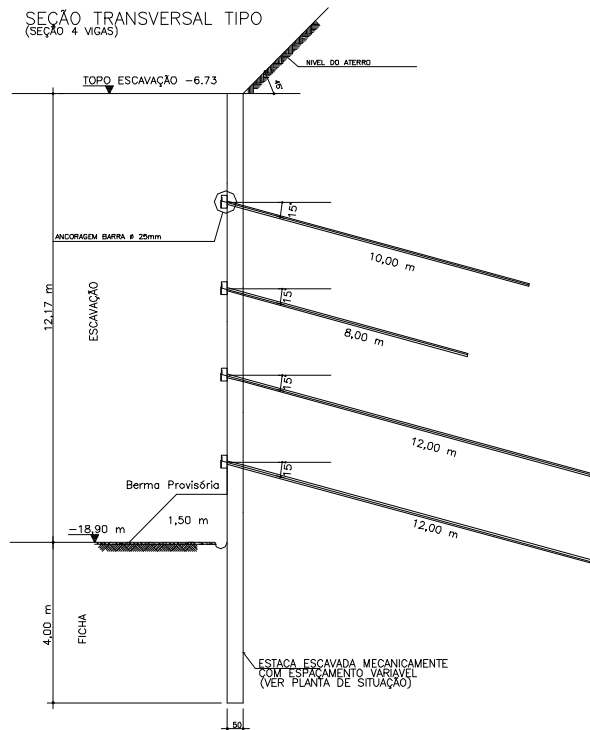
Seção Transversal Tipo da Fachada Oeste, Obra no Setor Bancário Sul (Fonte: Embre).
